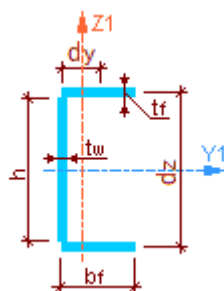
Схема профиля Швеллер сварной
